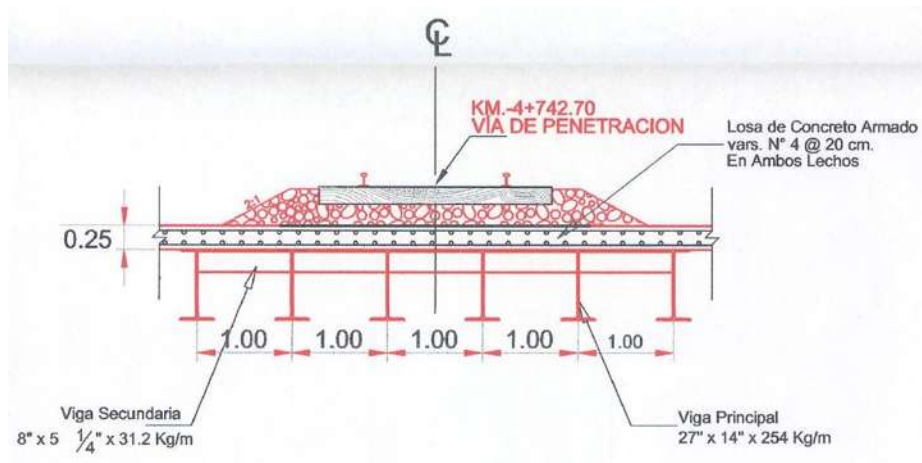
Detalle sistema de piso de la superestructura de acero estructural
